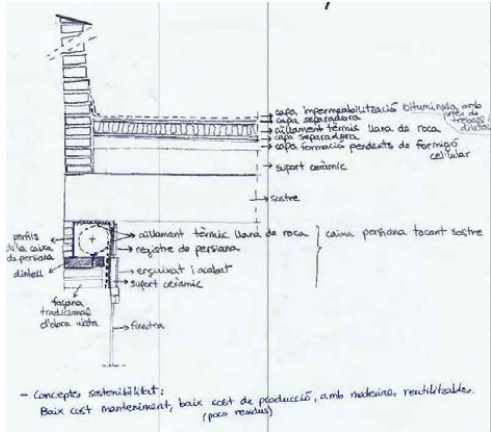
y Fig 6. Detalle: "Sección de cubierta plana en edificio con fachada de obra vista" Bloque 3 Proyectos Técnicos II. 2012. EPSEB
